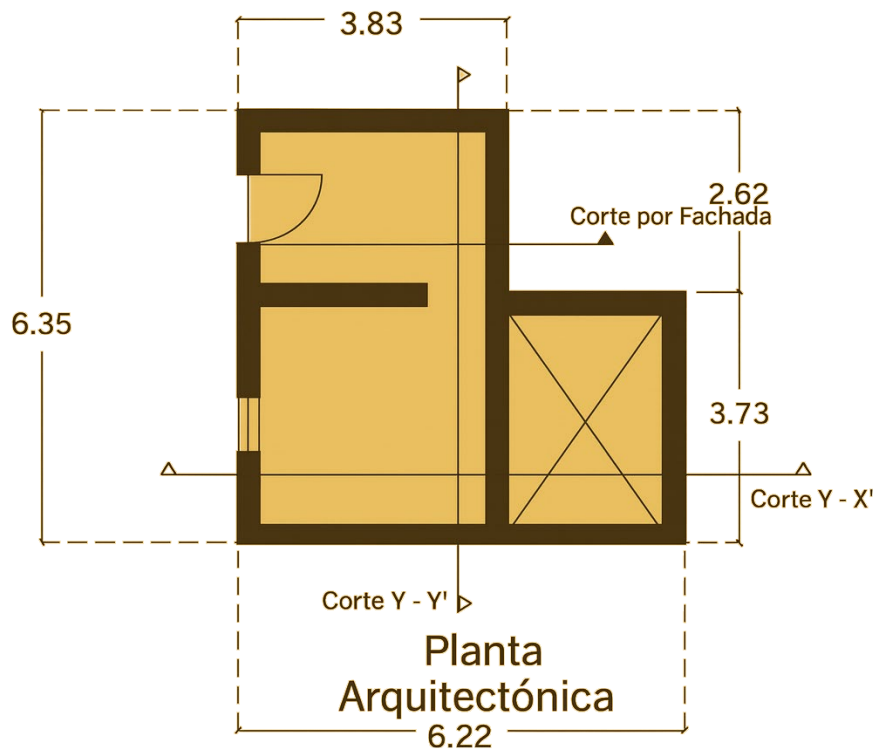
Plano de la planta del inmueble. Realizado por Hernández, 2018.
